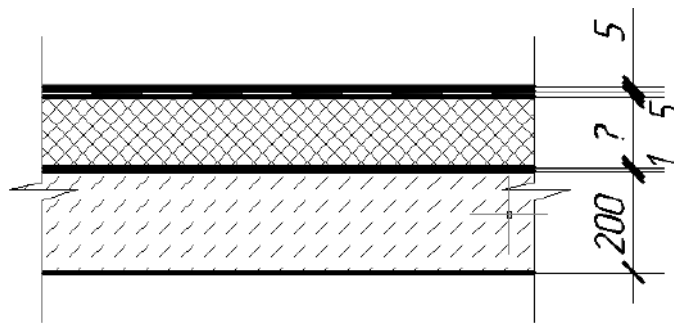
Розрахункова схема багатошарової конструкції покриття
